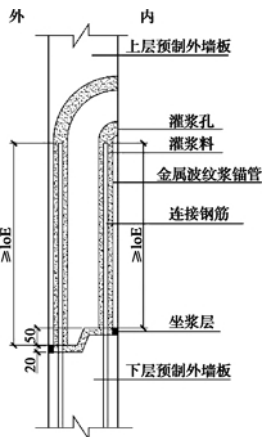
外墙板竖向钢筋分布式约束搭接连接示意图
